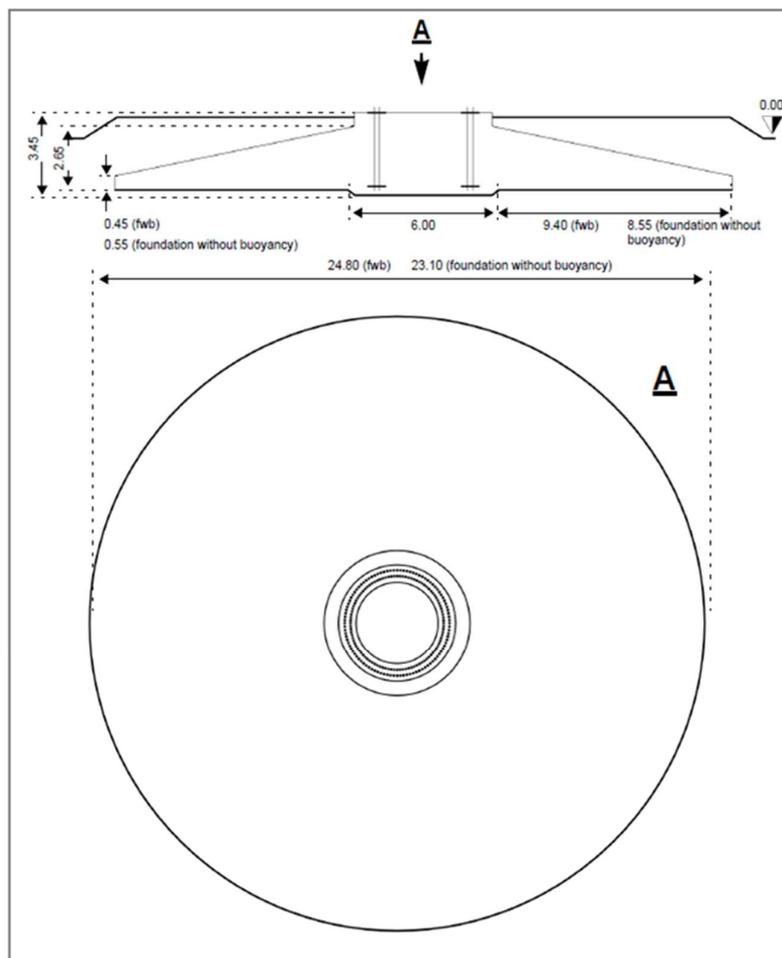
Planimetria e sezione "tipo" del basamento dell'aerogeneratore NORDEX N163 – 5,307MW
